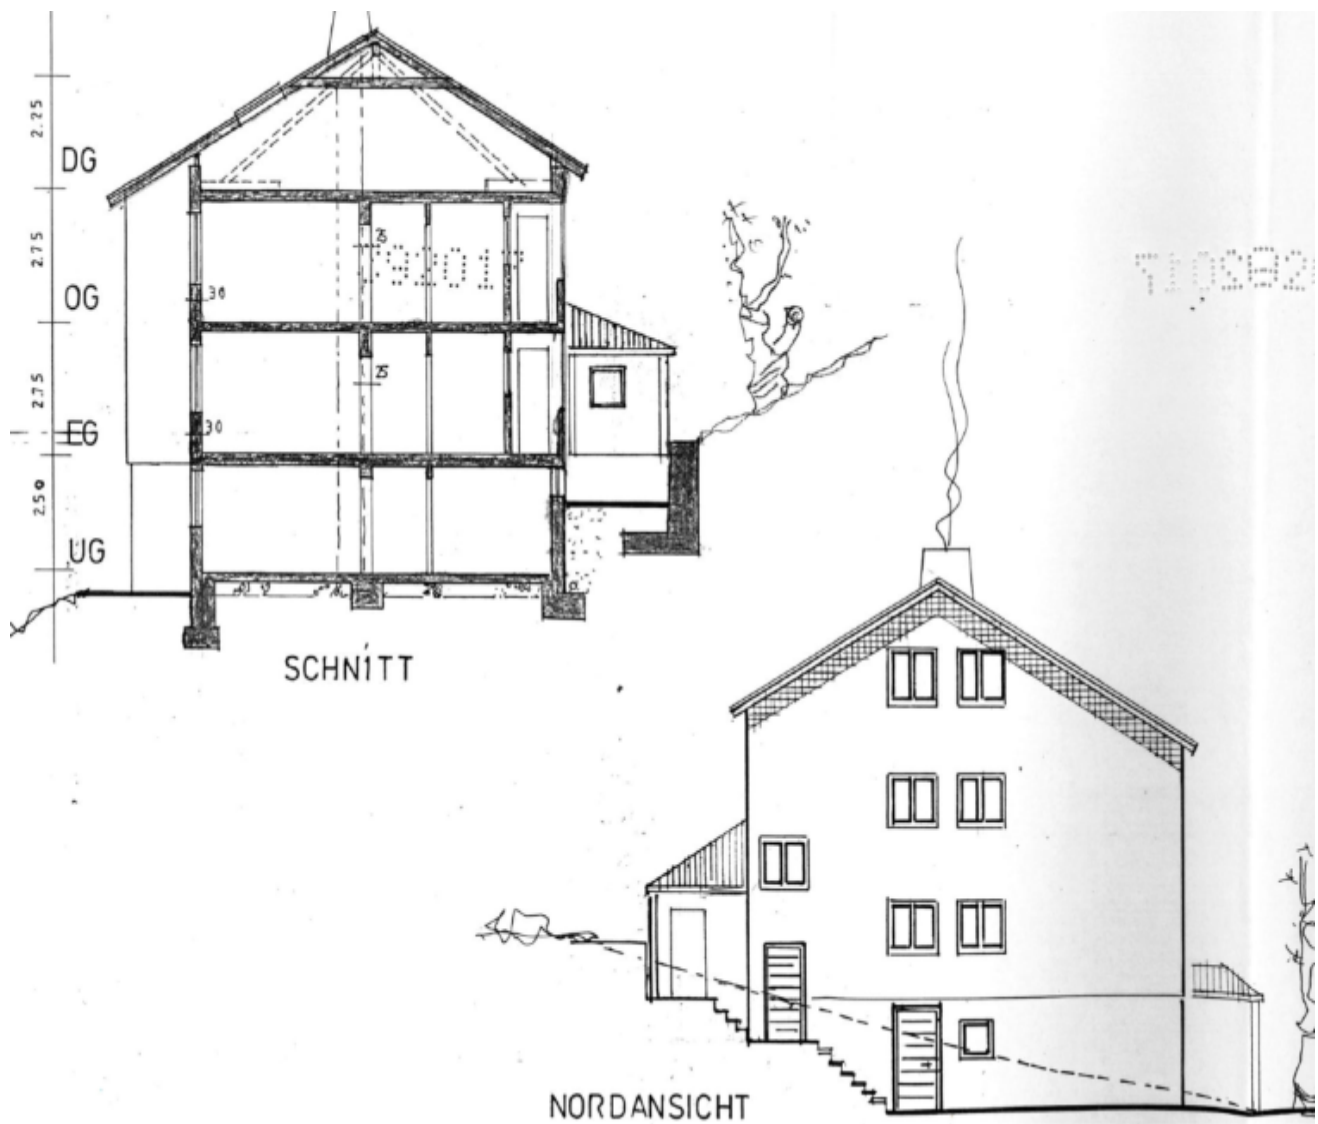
Gebäudeschnitt und Nordansicht; Quelle: Bauakte; Dachgeschossausbau Nachgesuch; 2017
